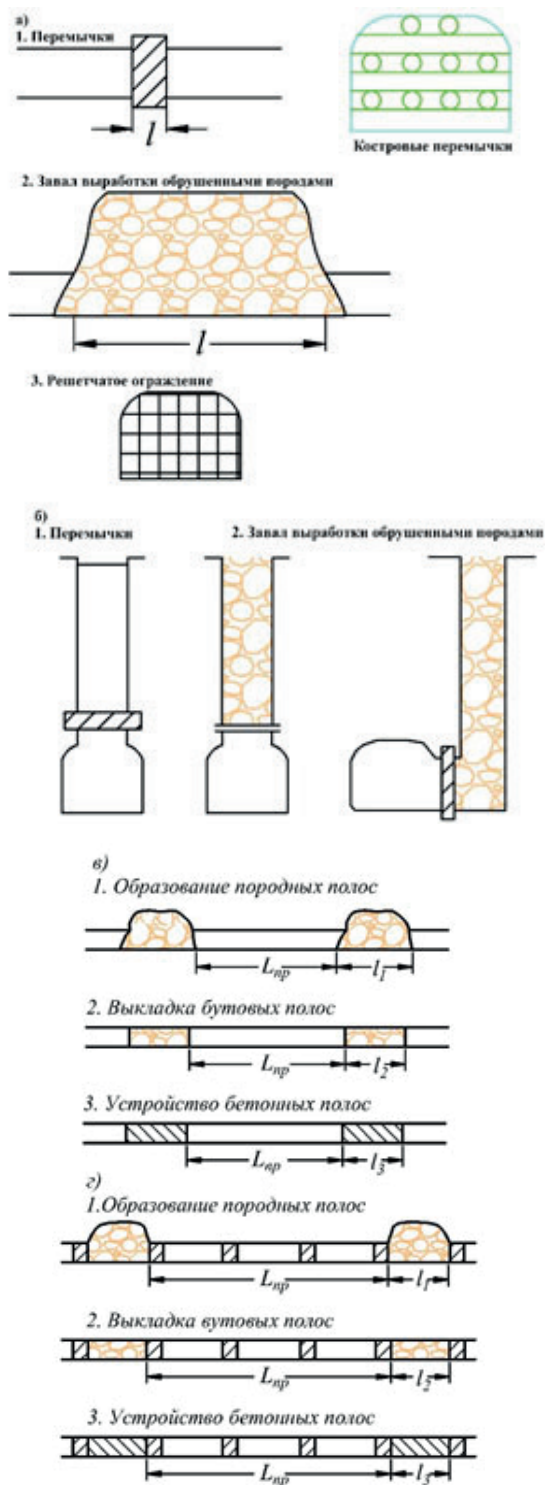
Изоляционные перегородки, установленные: а – в горизонтальных выработках; б – в вертикальных выработках; в – в очистном пространстве, при сплошной выемке, г – при камерно-столбовой системе
